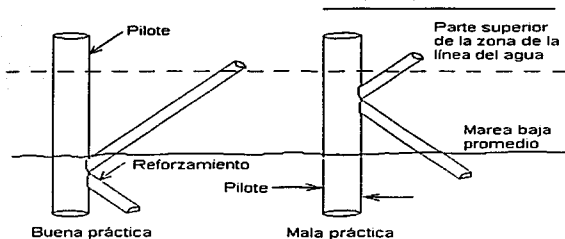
Soldaduras de unión e intersecciones de los reforzamientos que pueden estar alrededor o debajo de la línea de agua.
